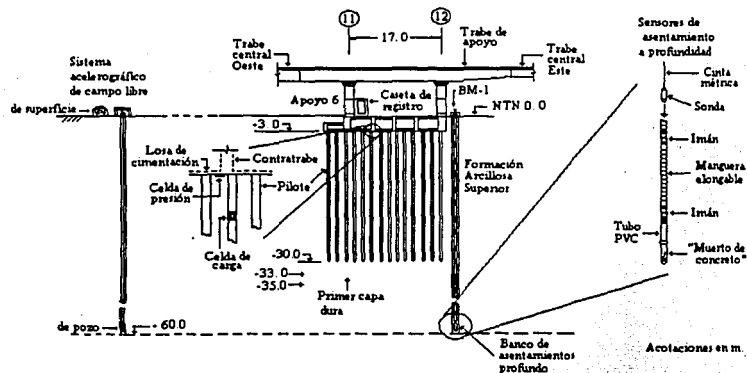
a. Perfil de la cimentación del puente Impulsora.
